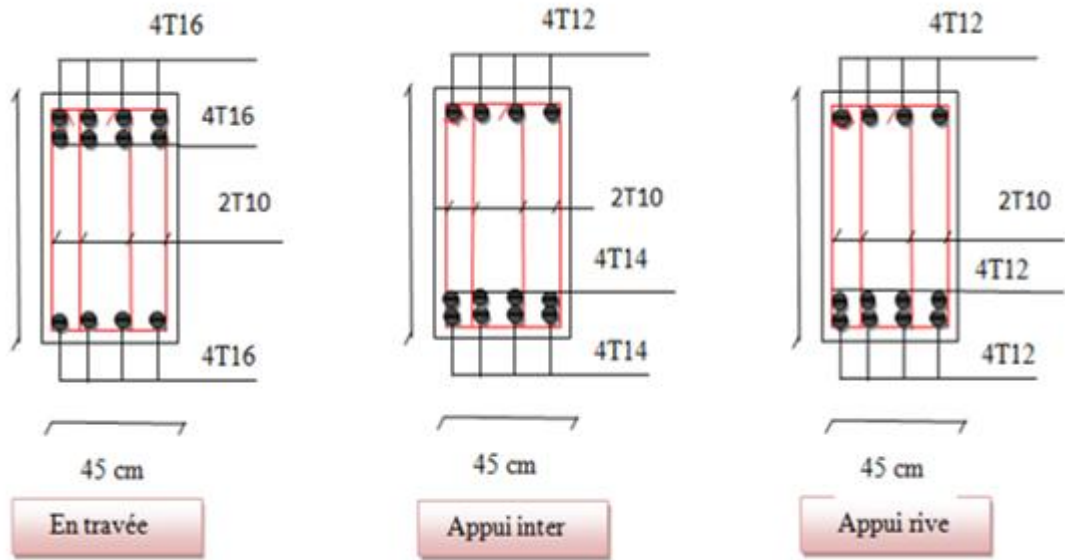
Ferrailage de la poutre de libage suivant le sens transversale.
